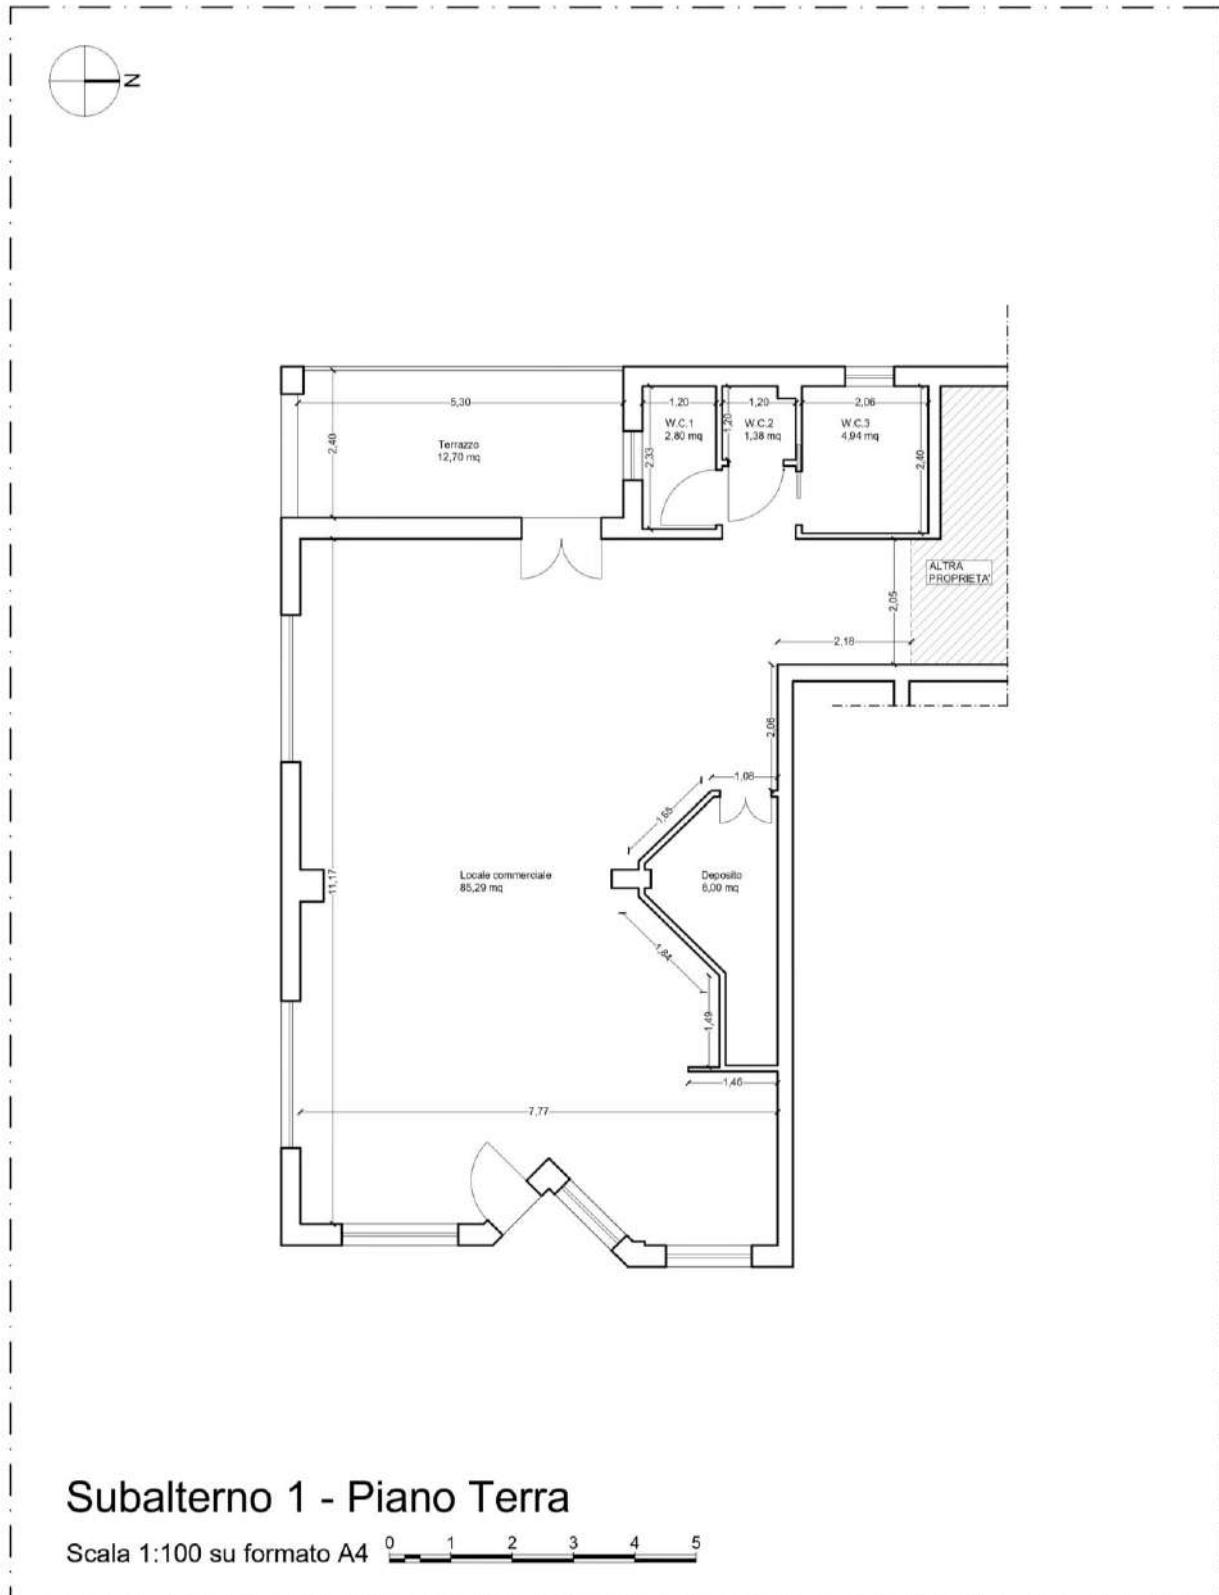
Planimetria dello stato di fatto – Subalterno 1 – Piano Terra
